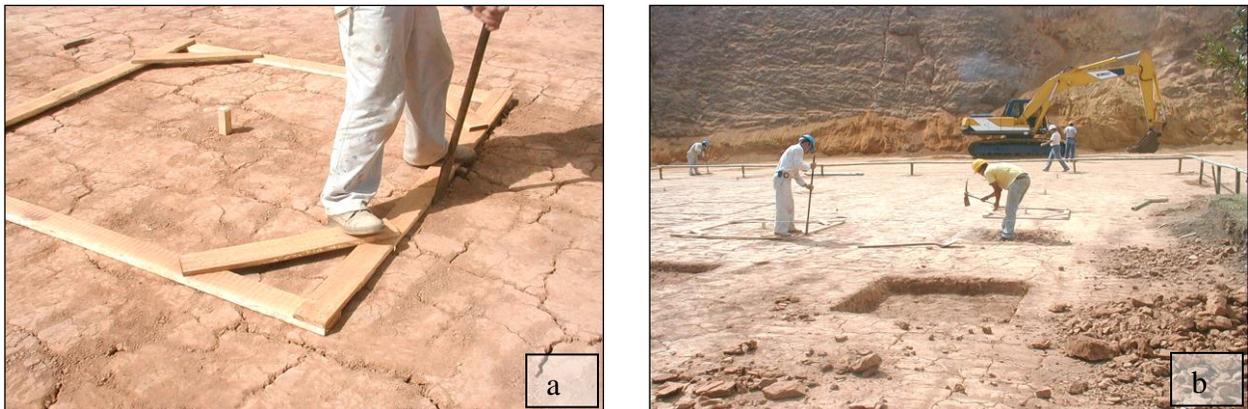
a) Detalle plantilla para demarcación de zapatas, b) Proceso de excavación de zapatas.
